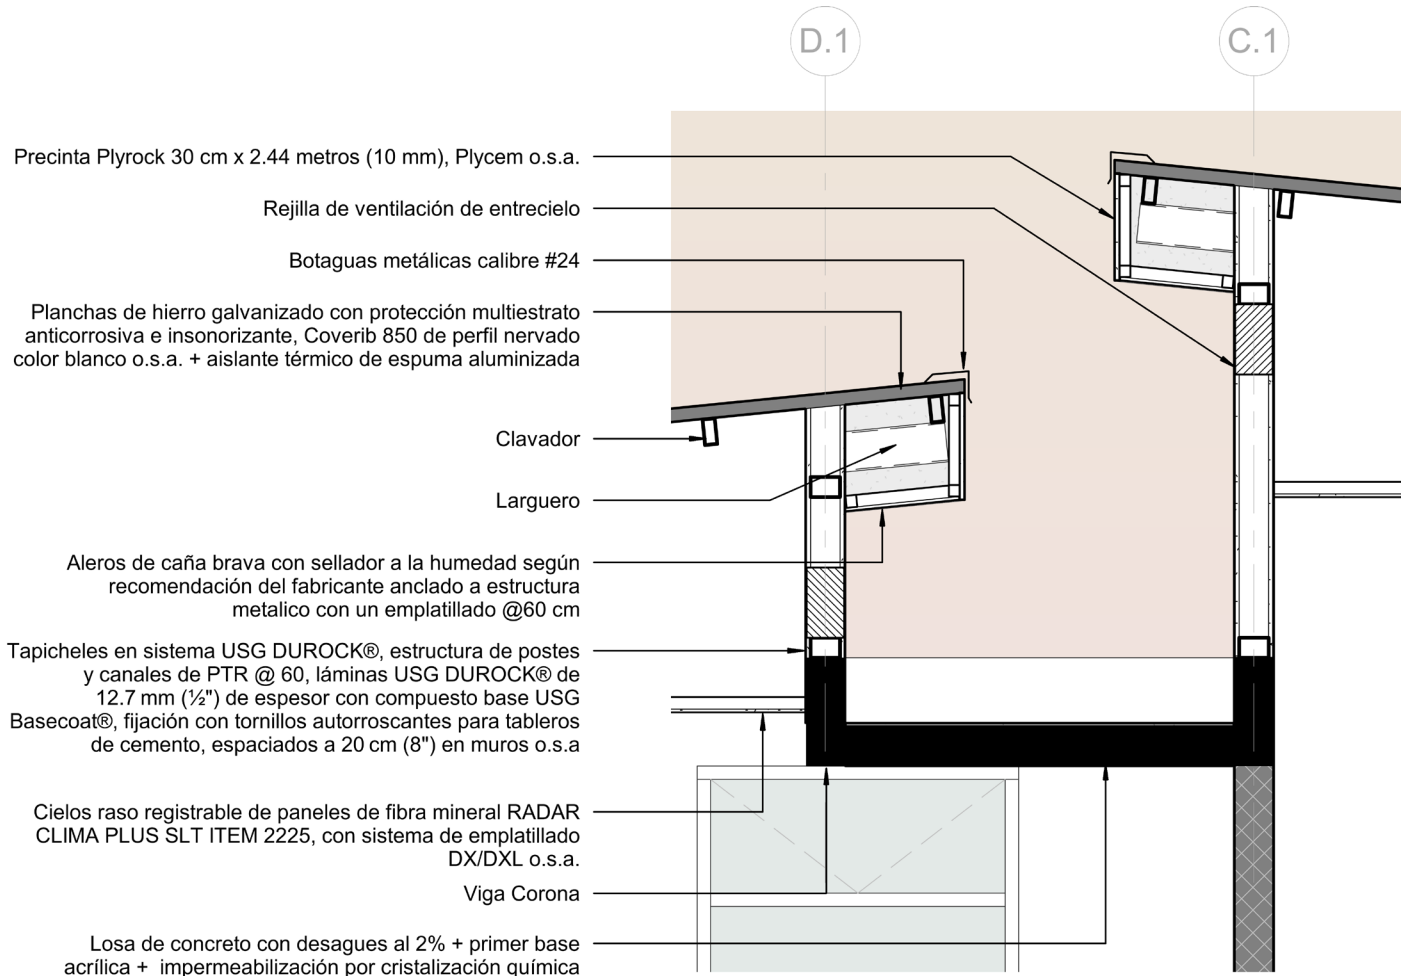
Detalle de Losa de concreto y cubiertas. Fuente: Elaboración propia
